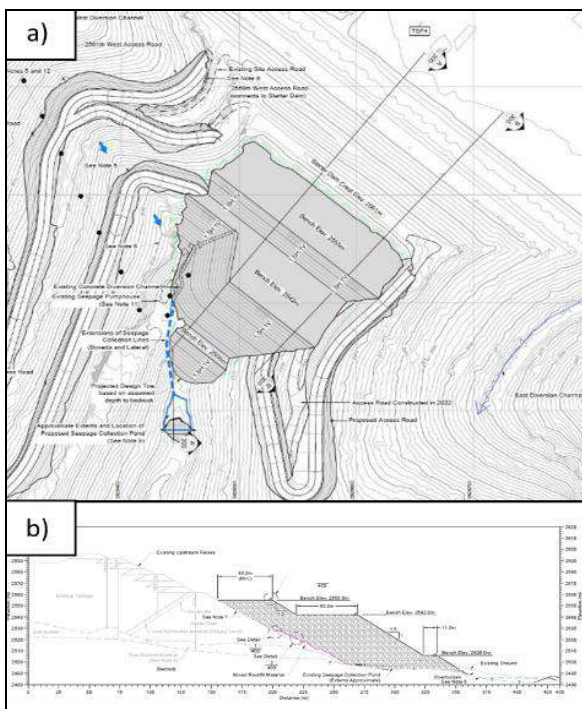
Sabinas: (a) vista en planta y (b) elevación en bordo principal.
